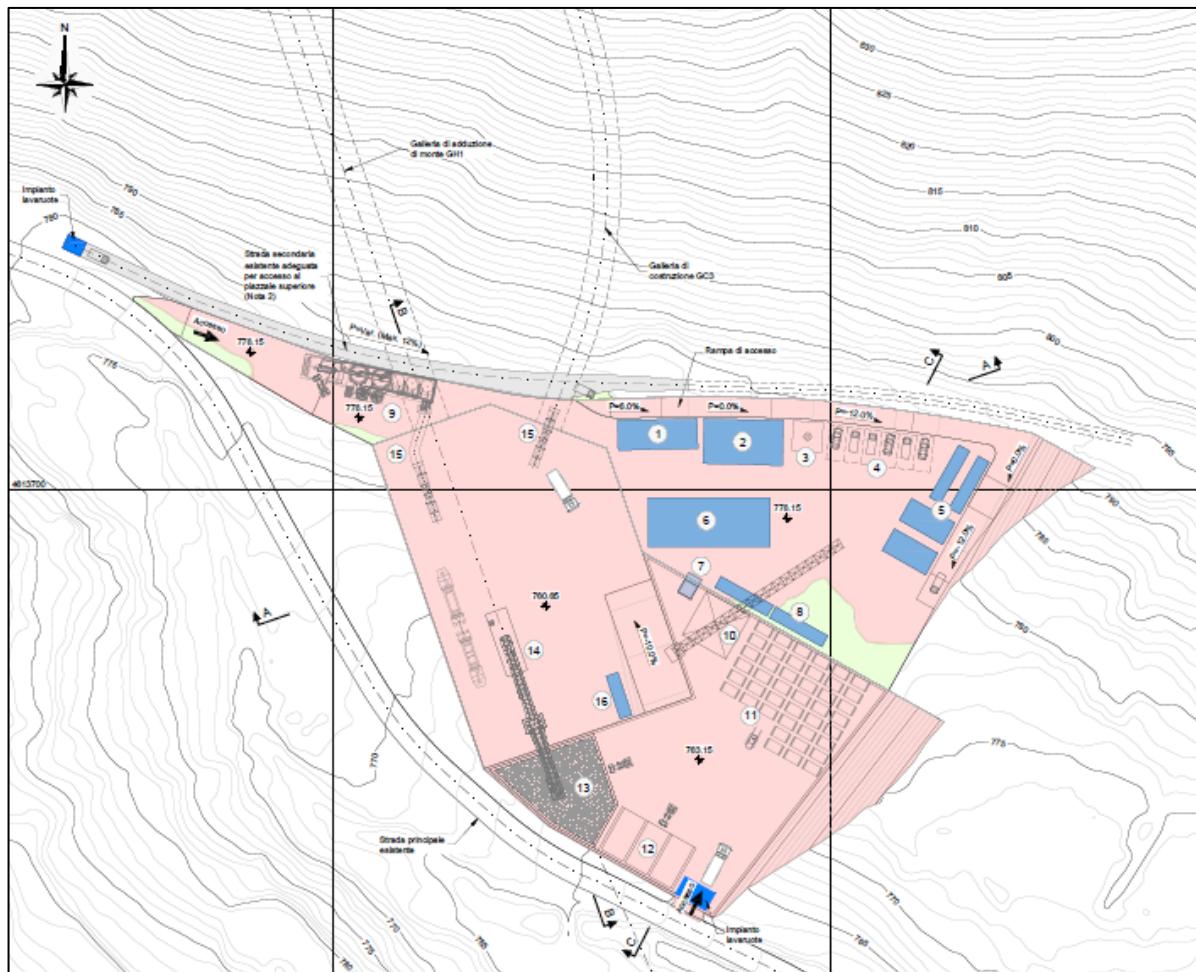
Ambito Pizzone - Area di cantiere CO.04 – Zona di lancio TBM di monte
